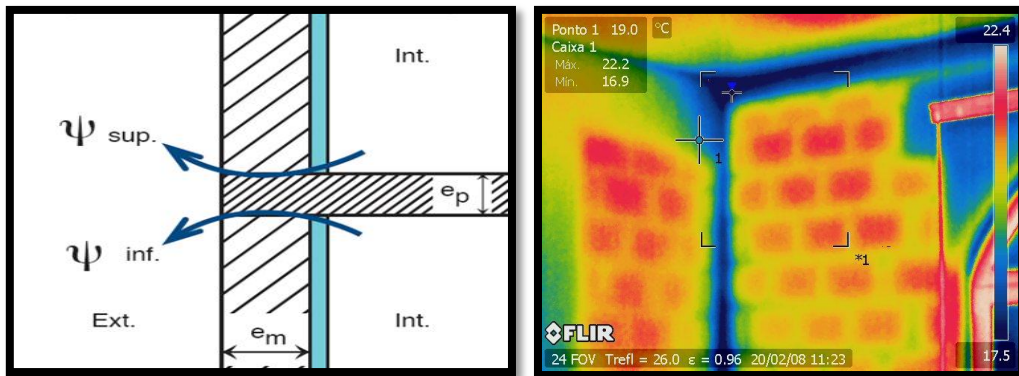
Ligação da Fachada com Pavimentos Intermédios; fonte: RCCTE (2006); Finn M. (2004)
